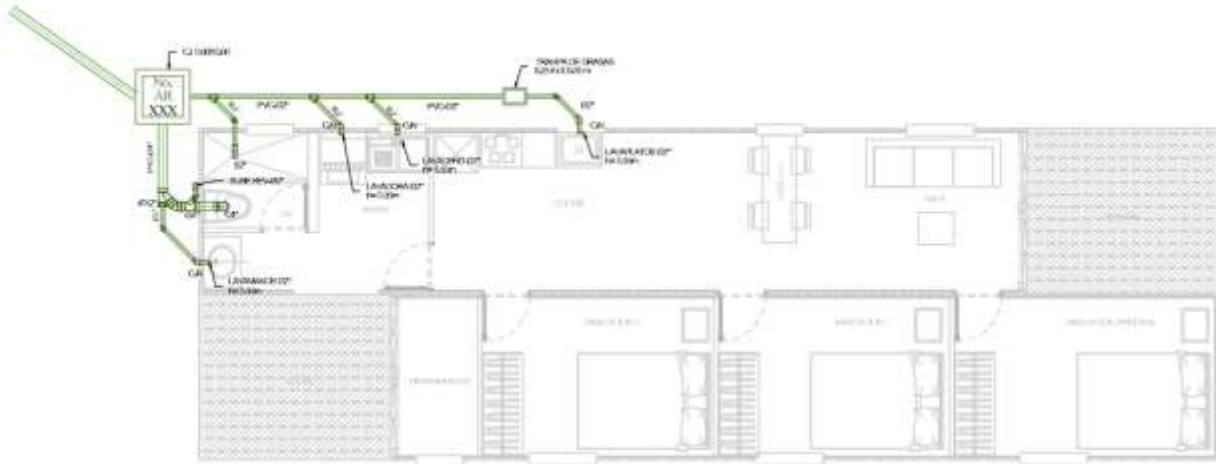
, Planta Diseño Residual #2 Final, 2025-II, Wilson Lozano
